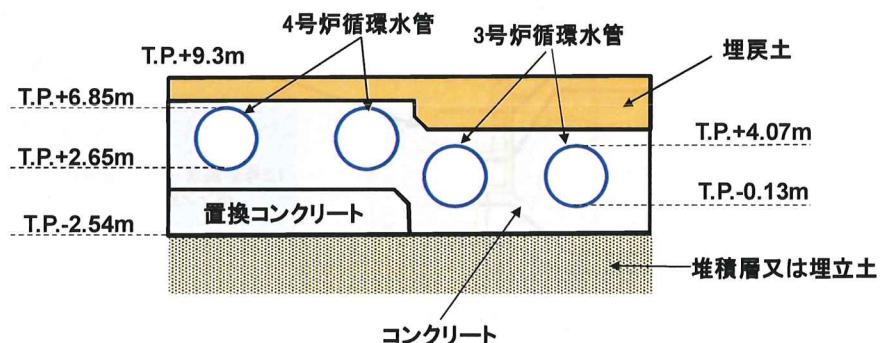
3, 4号炉循環水管埋設部③断面図
